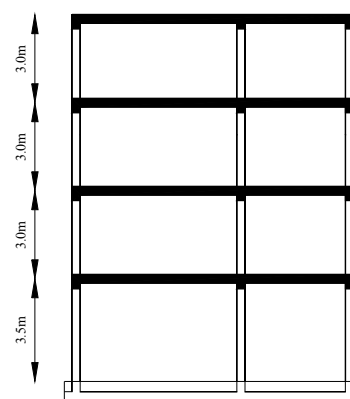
Configuração em alçado da estrutura de 4 pisos
